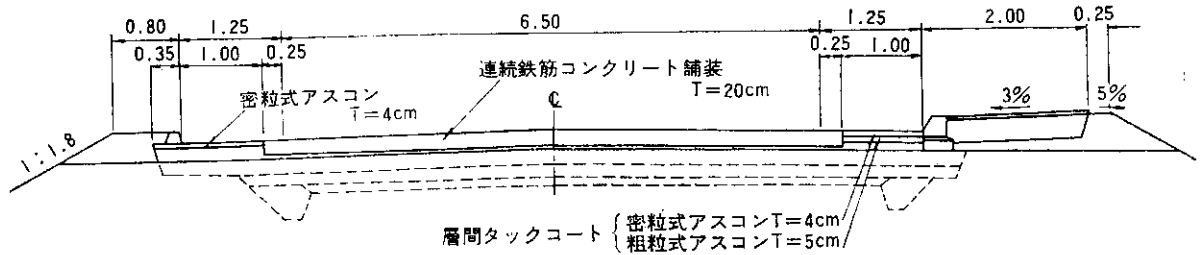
連続鉄筋コンクリート舗装定規図 (単位:m)
